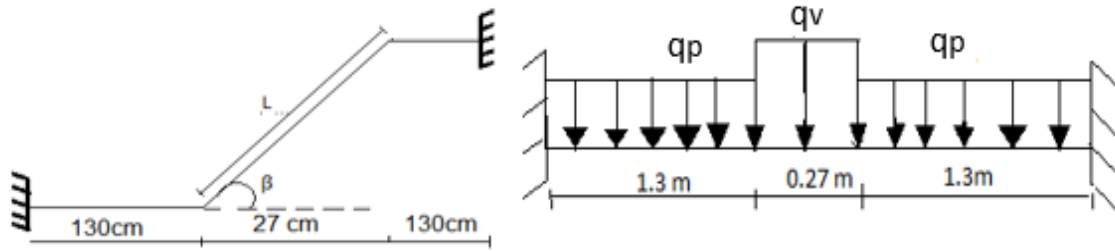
Coupe en élévation de l'escalier type 02 Figure III.32. Schéma statique de l'escalier type 2
